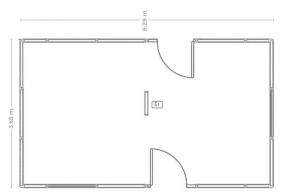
Planta Vivienda Smart panel Tipo 2. Fuente: Fábrica FV.
